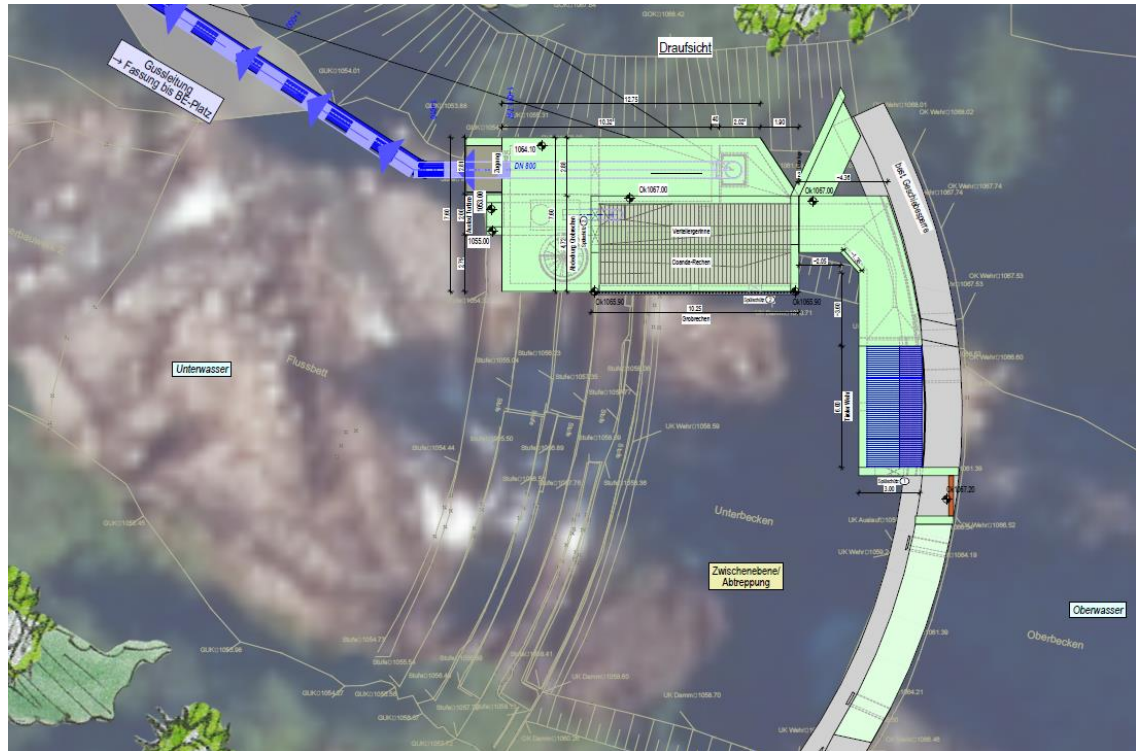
Draufsicht geplantes Fassungsbauwerk
